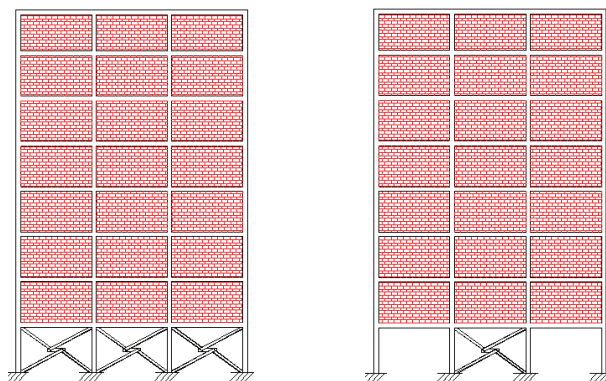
Disposição das soluções de reforço adotadas para a direção transversal – k-bracing.
